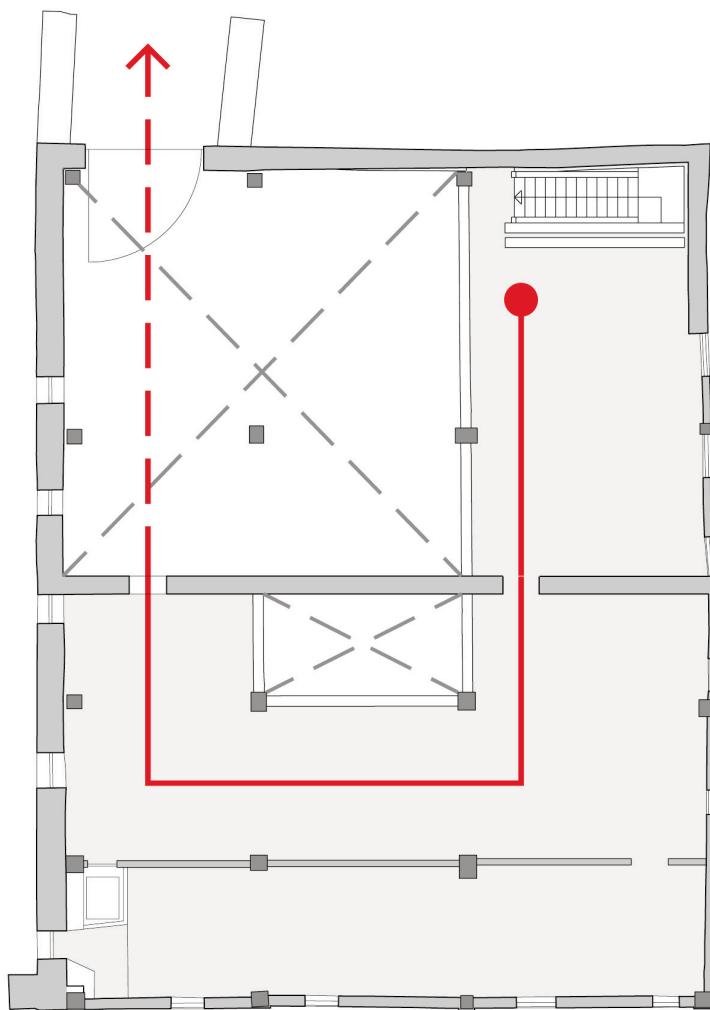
Primera planta del caserío Zabalaga. Recorrido.
